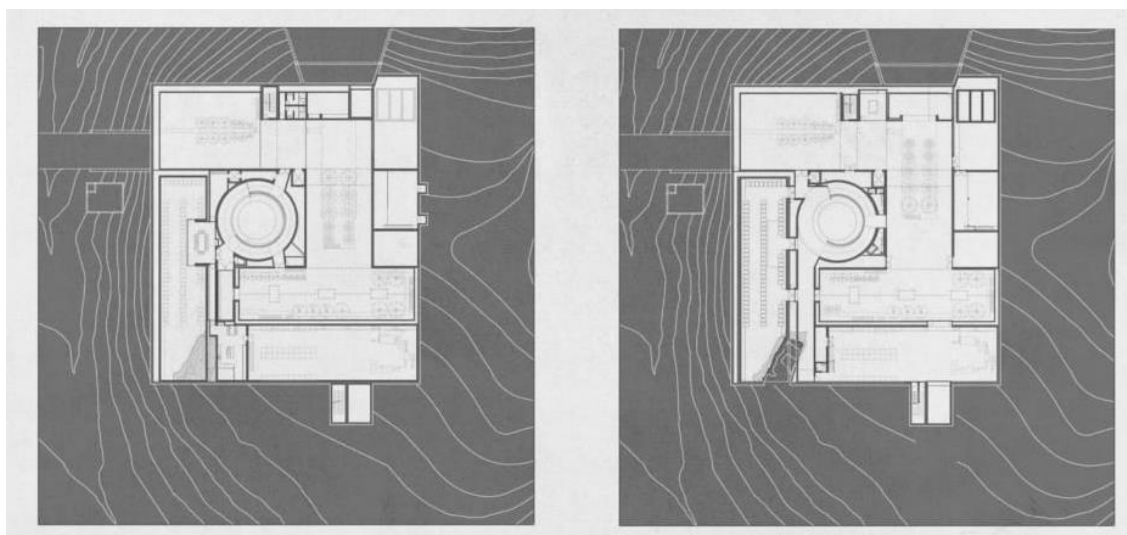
Planta dos piso -1 e -2 da adega do Freixo ²⁵⁹
